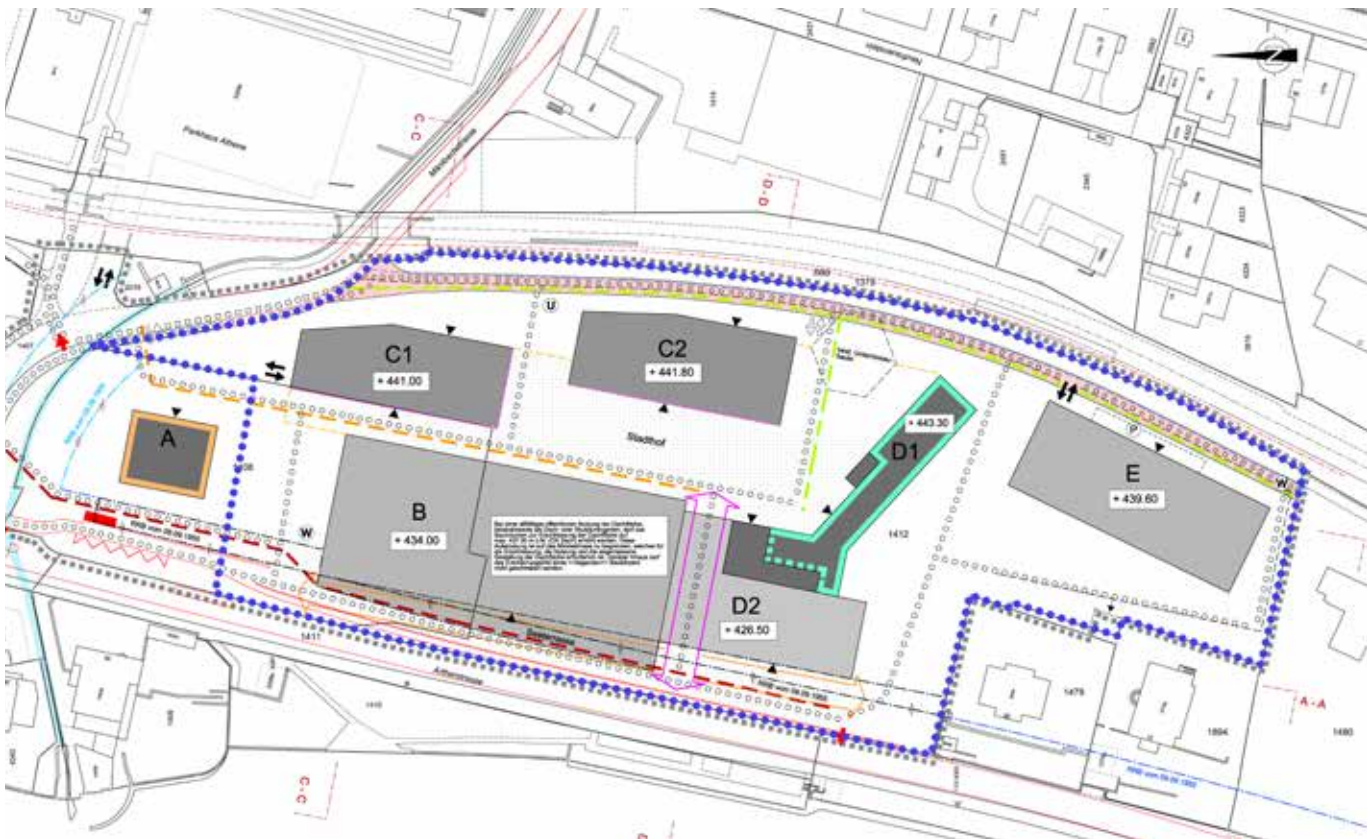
Darstellung Projektperimeter (blau) mit Baubereichen (Quelle: Bebauungsplan)
